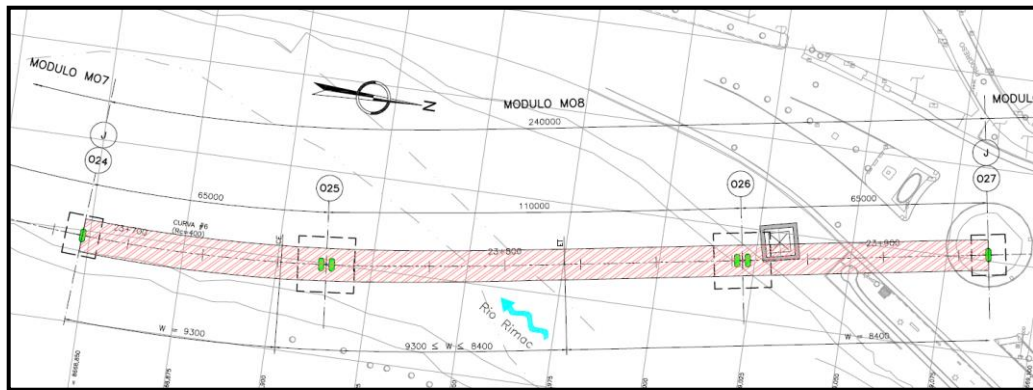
Planta Módulo MO8 (Puente sobre el Río Rímac)
